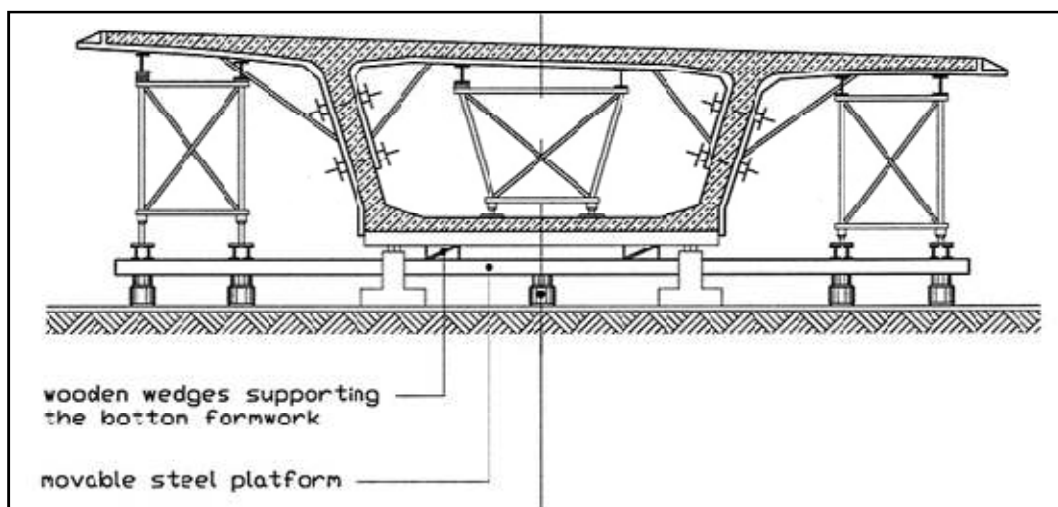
Seção transversal da aduela posicionada para execução do empurramento
